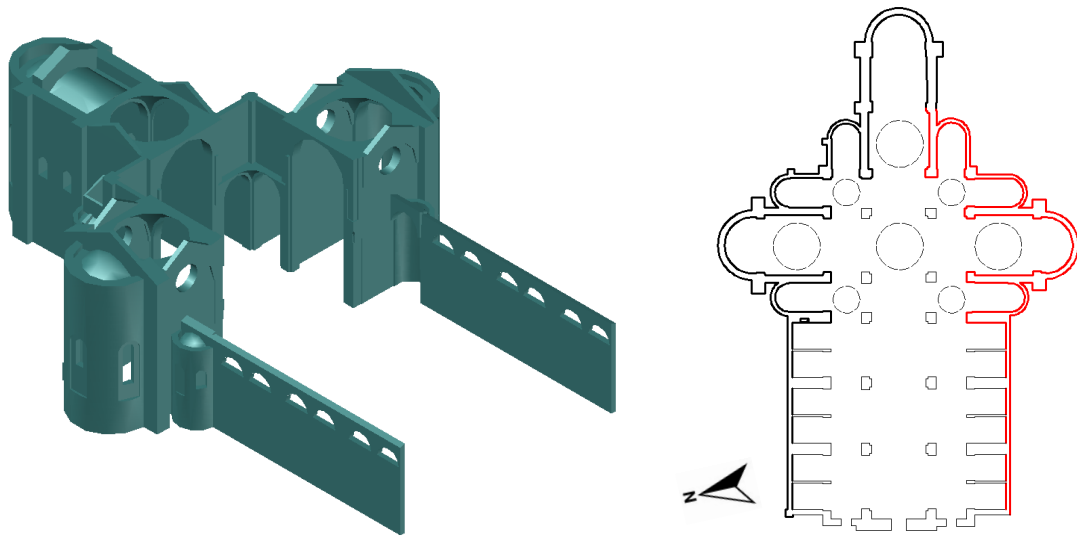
Vista assonometrica e pianta della fase 2 della struttura.
